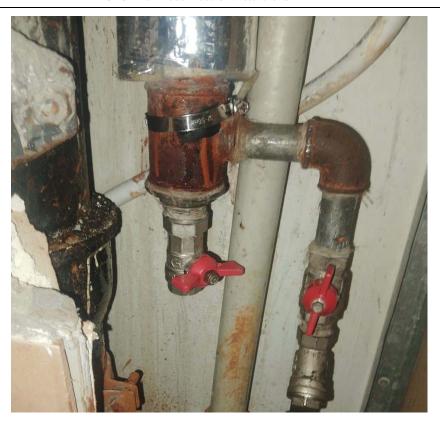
Коррозия резьбового соединения. Коррозия сварного соединения Значительная коррозия трубопроводов.
